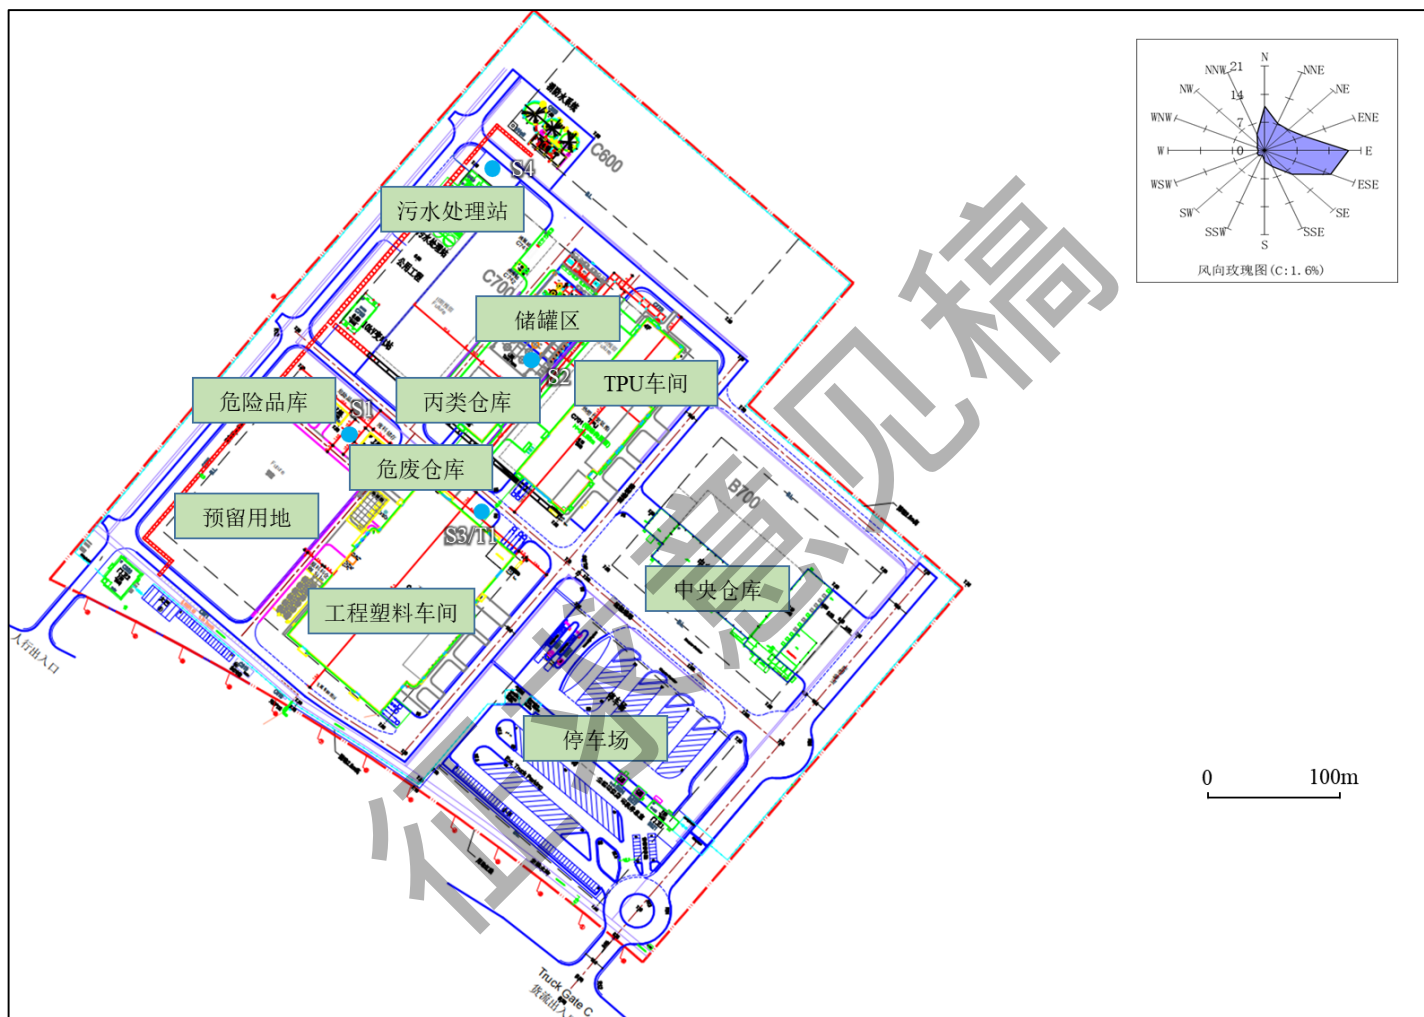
巴斯夫（广东）一体化项目首期总平面图
